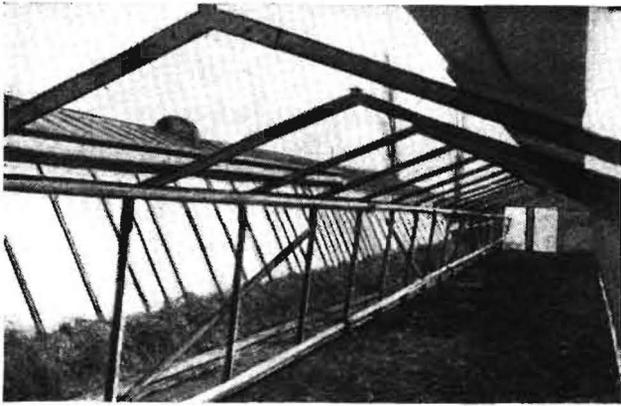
Primitiv-Bauweise (Tempo) mit transportabler Heizungsanlage im Aufbau (Regneröhre)
